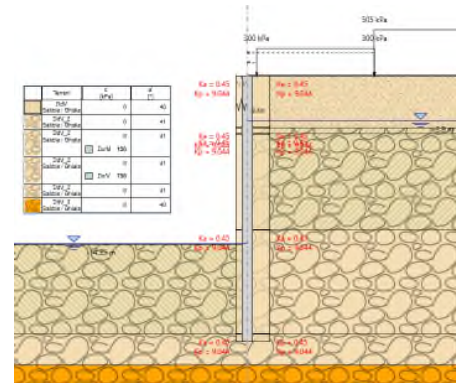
Raggiungimento fondo scavo (Stage 2)
